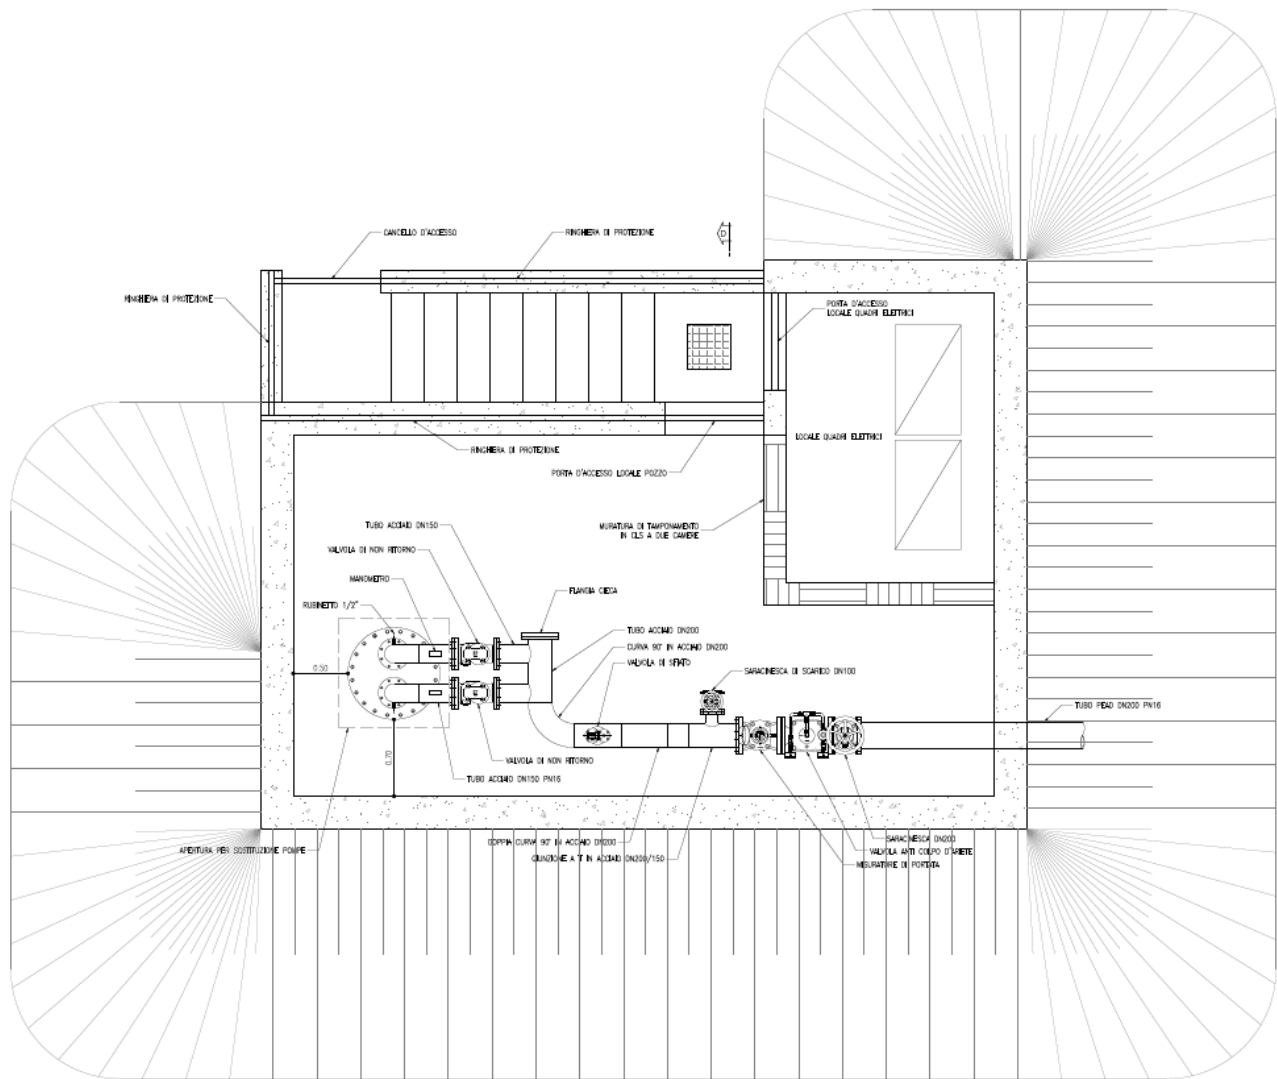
Estratto tavola IB0U1BEZZBZID0002009B, pianta manufatto pozzo; sorgente S2
